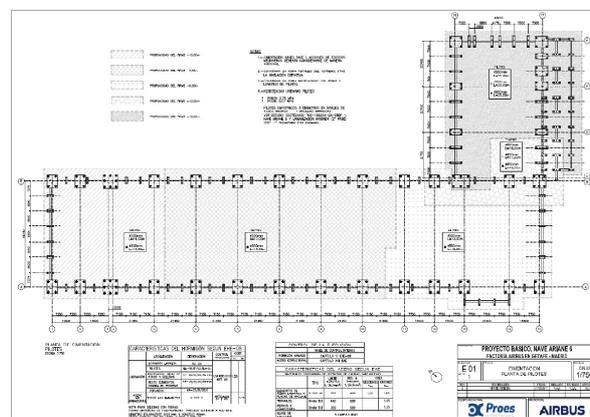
Planta cimentaciones Nave Industrial y Sala limpia.
